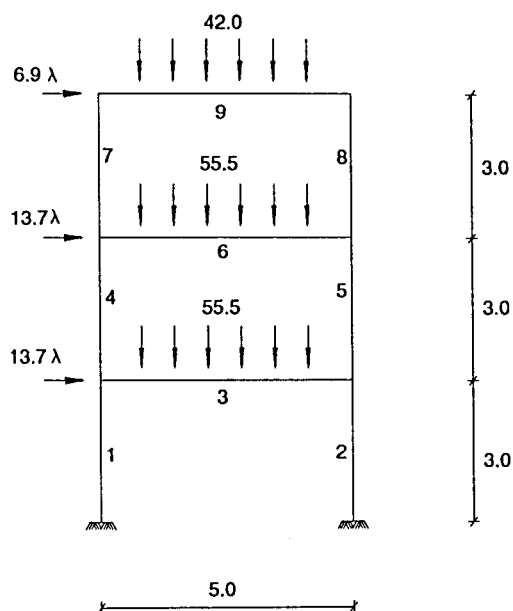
Assimetria estrutural. Pórtico PORT3A2 (kN,m)
